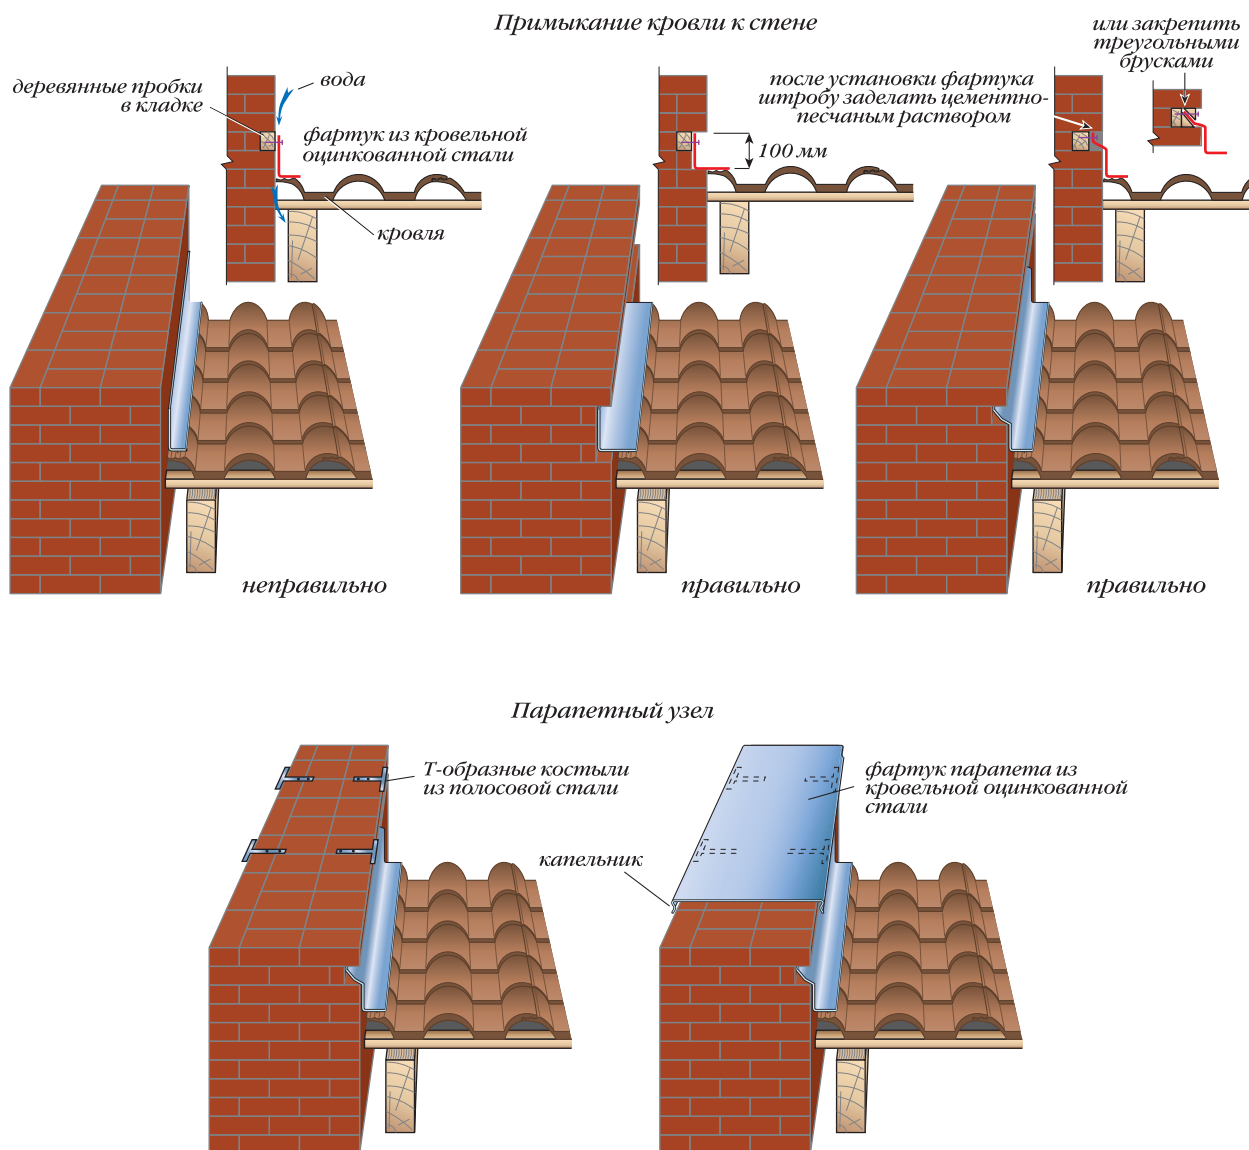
Традиционные решения узлов примыкания кровель к стенам и парапетам
